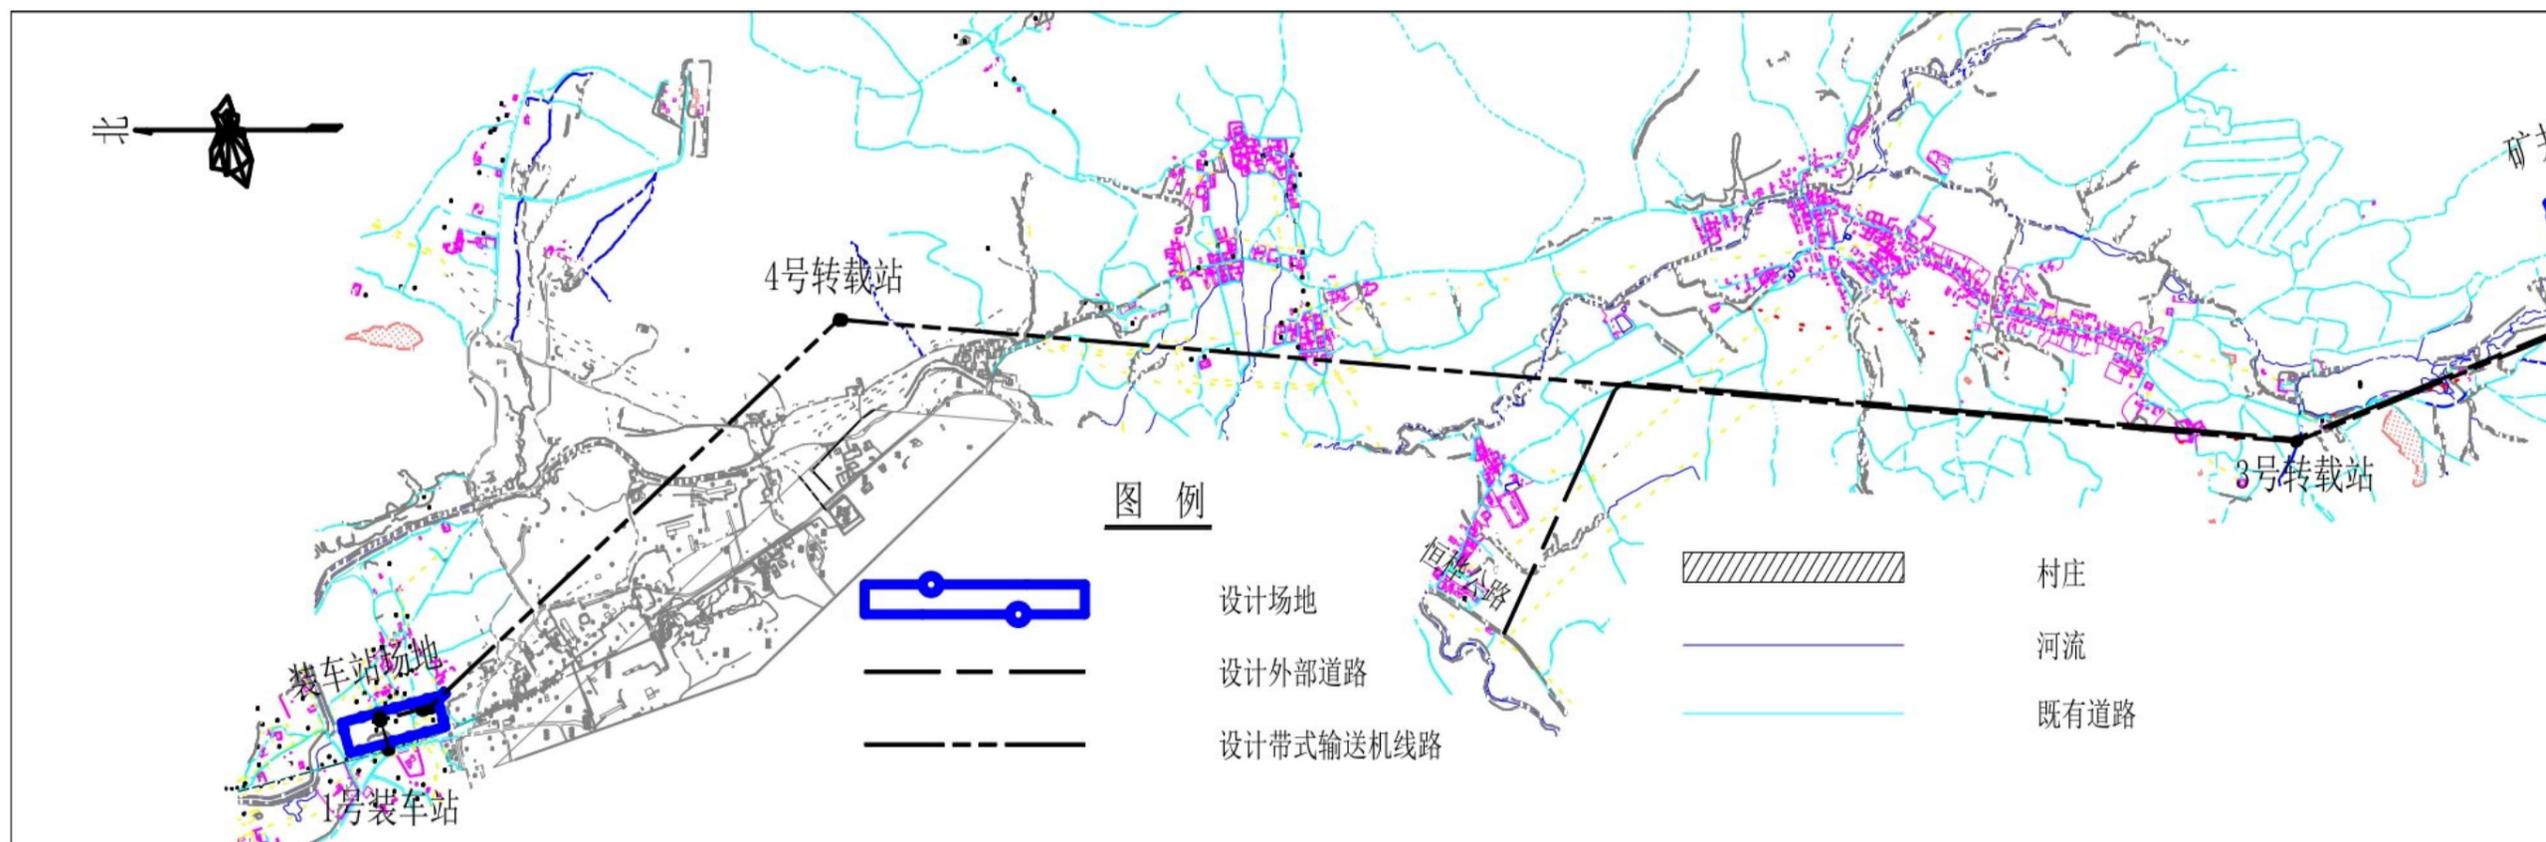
矿区规划场外长距离带式输送机平面布置图
